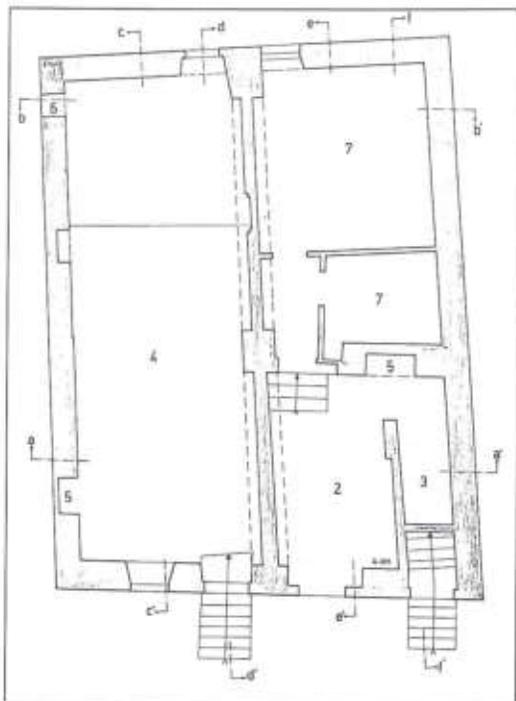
/ Pianta dell'edificio collocato tra via S. Andrea (prospetto principale) e via delle Caprarecce.
